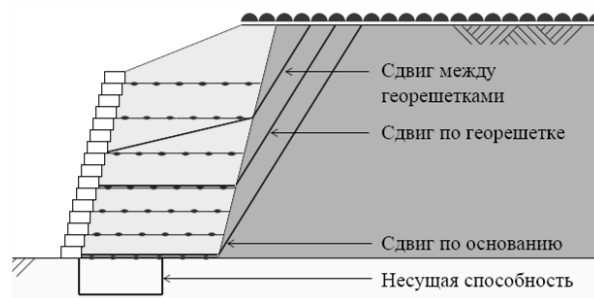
Поверхности разрушения, не пересекающие армирование
